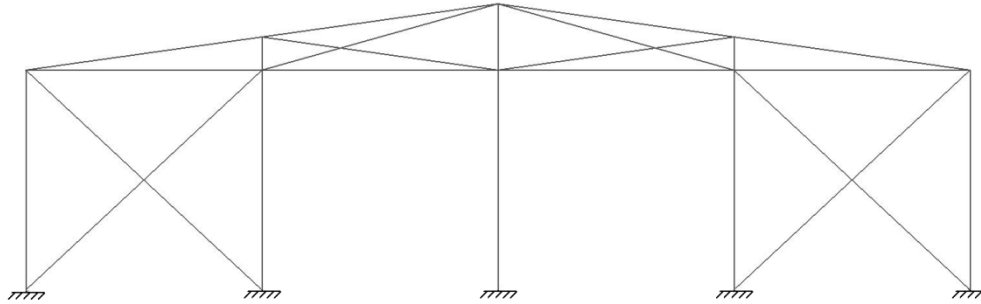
Arriostramiento de las cabezas de los pilares del pórtico de fachada
